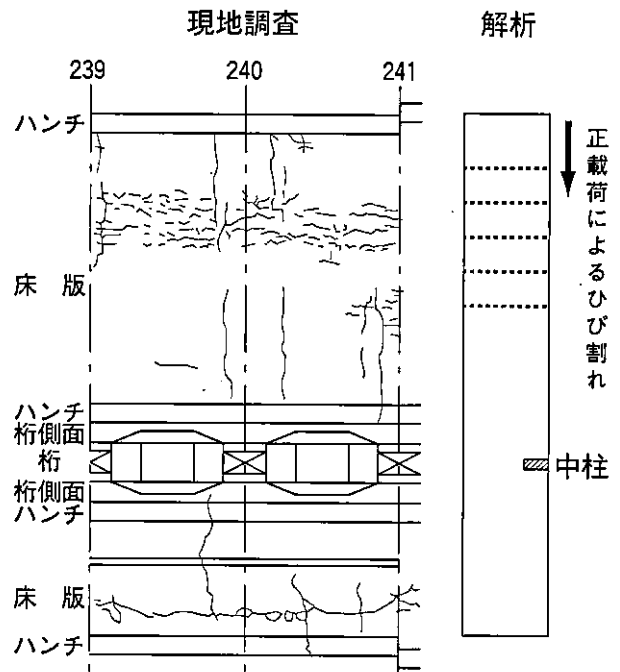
上床版 (下面ひび割れ状況) Cracks on the Upper Slab
